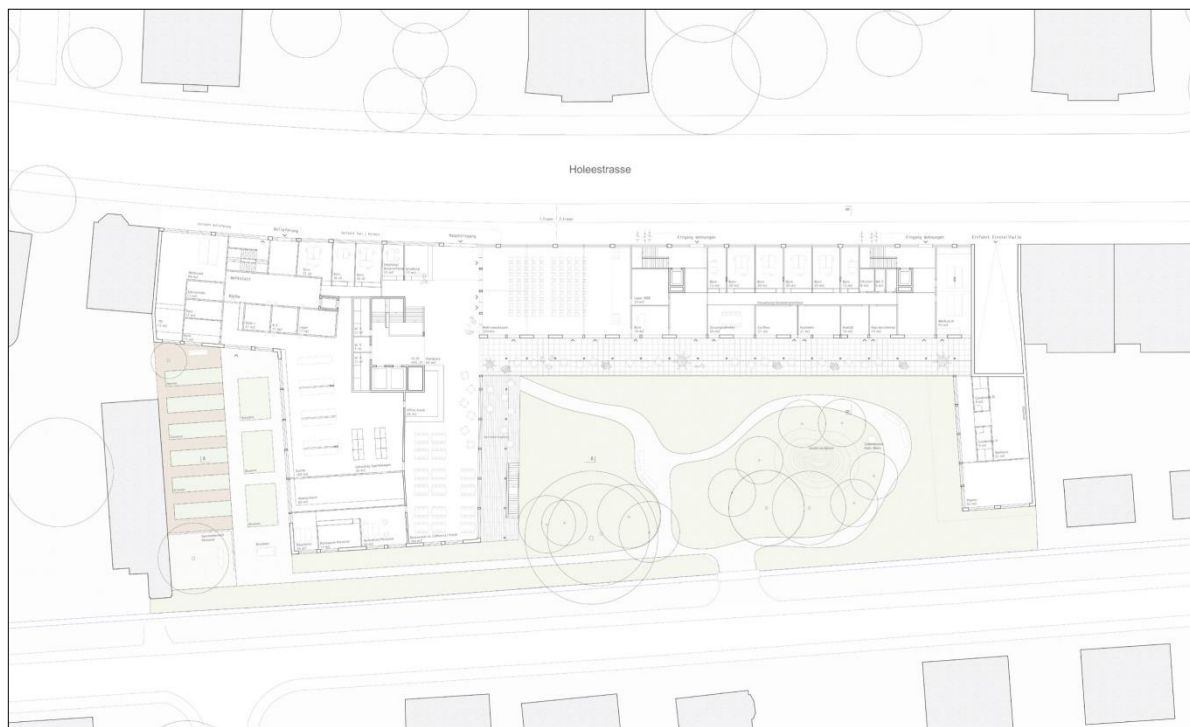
Erdgeschoss mit Aussenraum. Quelle: Ackermann Architekt BSA SIA AG, 2015
